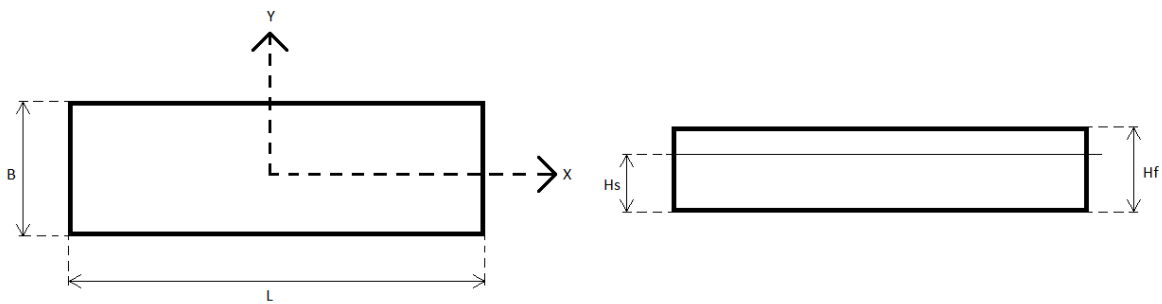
Vistas planta y perfil longitudinal fundación.
